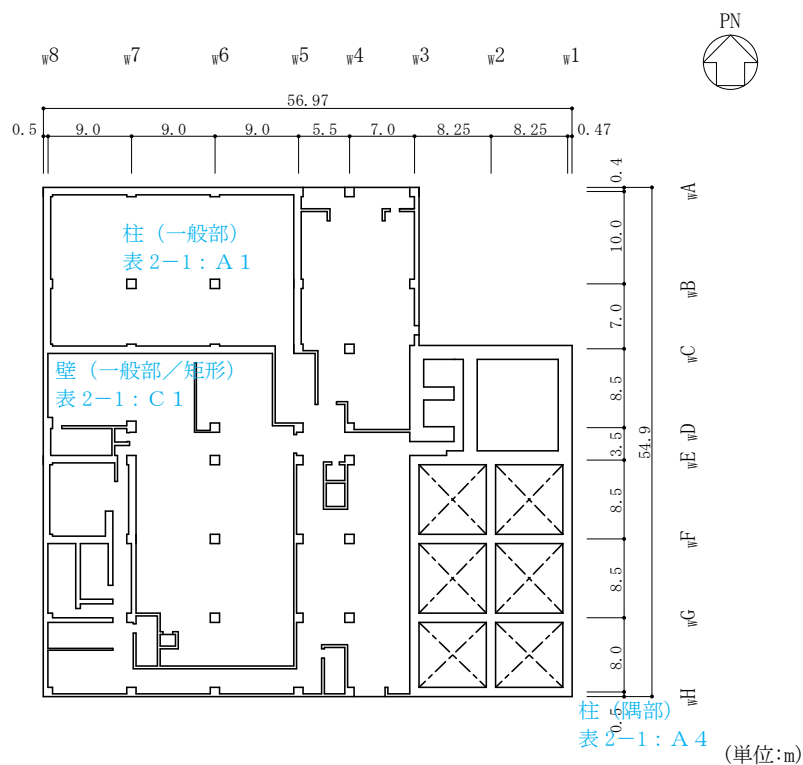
(7) 廃棄物処理建物の概略平面図 (EL 32.0m)
